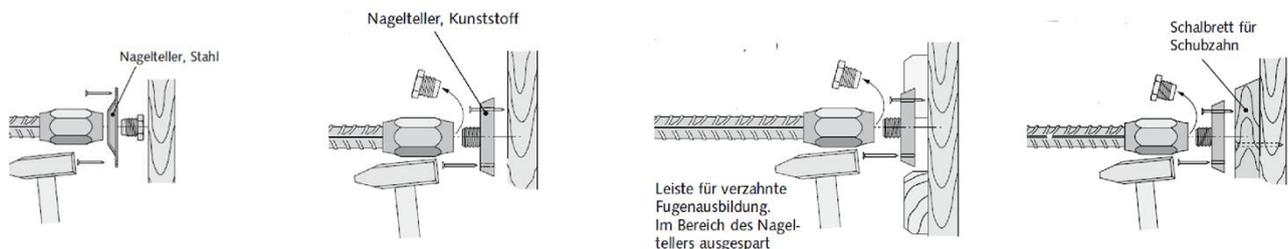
Befestigung mit Nagelteller (Befestigungszubehör)
